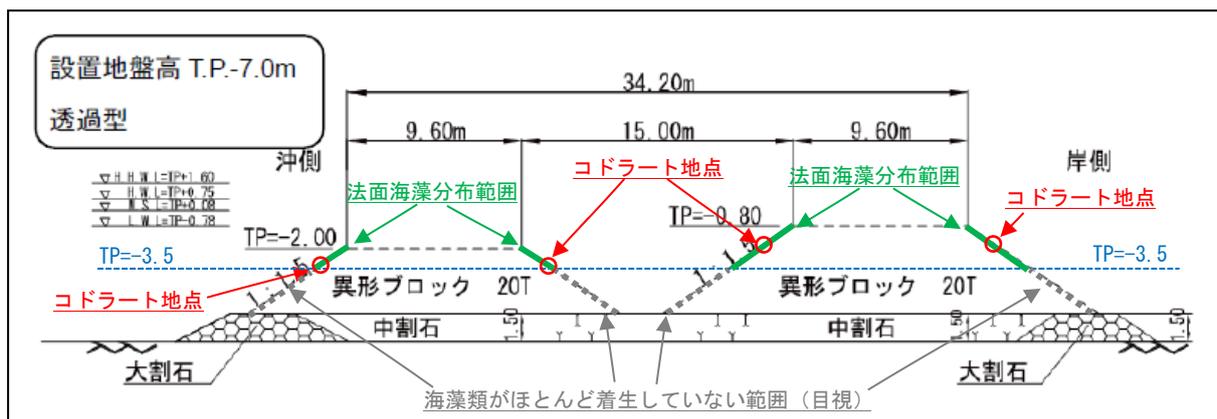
付着状況調査 (コドラート) 地点・法面海藻類分布範囲 (断面図 : 1 基目~4 基目)
